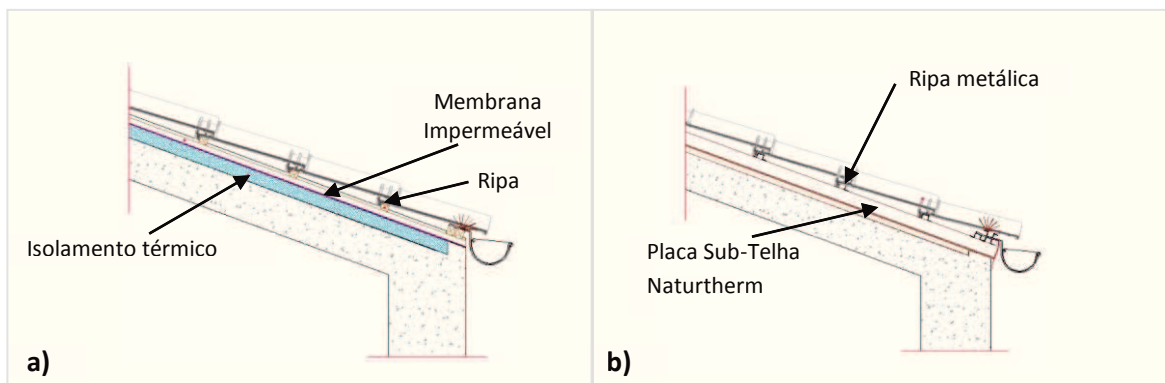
Soluções estruturais construtivas de cobertura com beiral ventilado.
